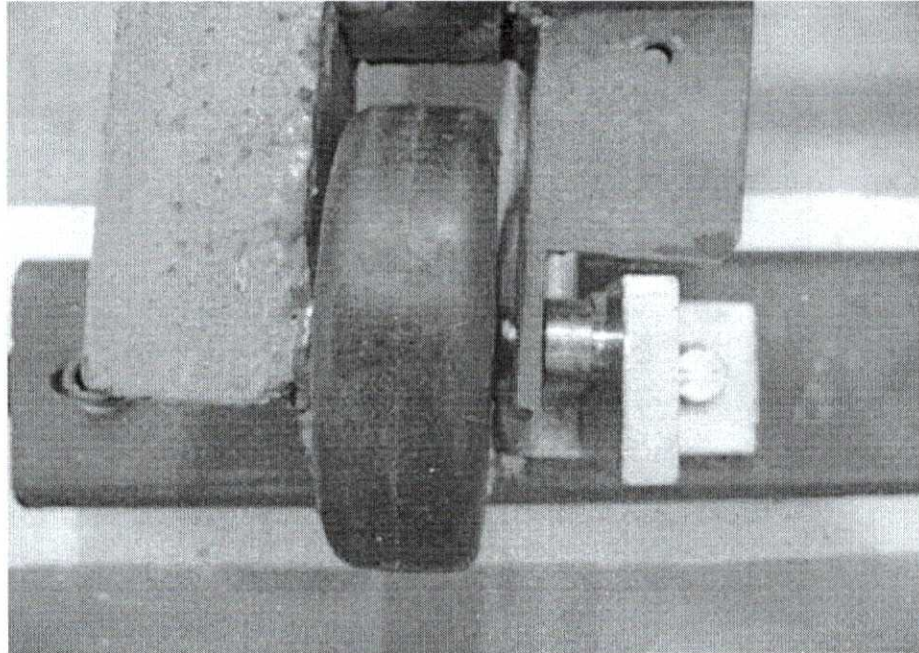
Lado esquerdo da amostra 2 após ensaio.
